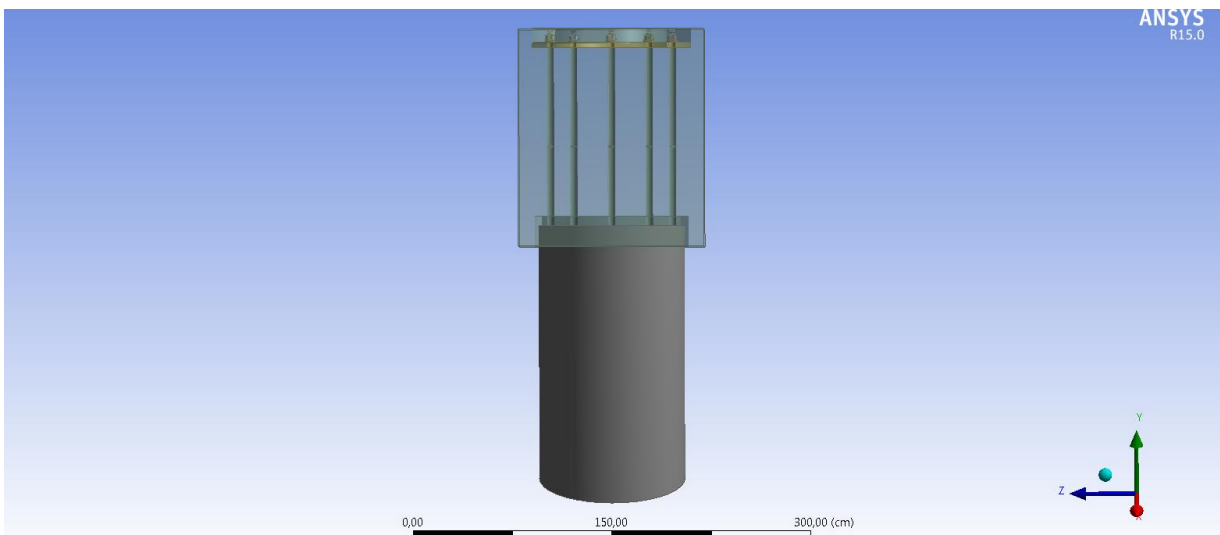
Vista lateral de conexión con pilote inclinado.
